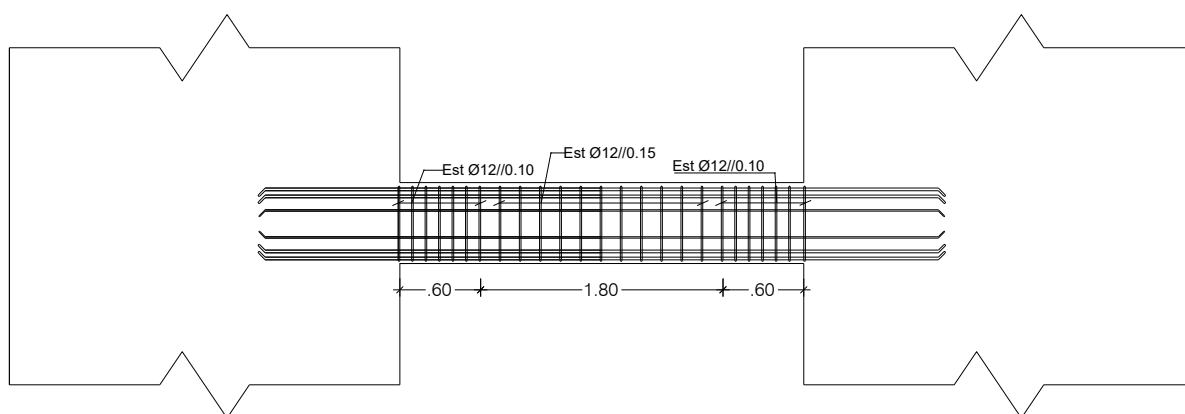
Secção longitudinal da viga de acoplamento PA_60%
